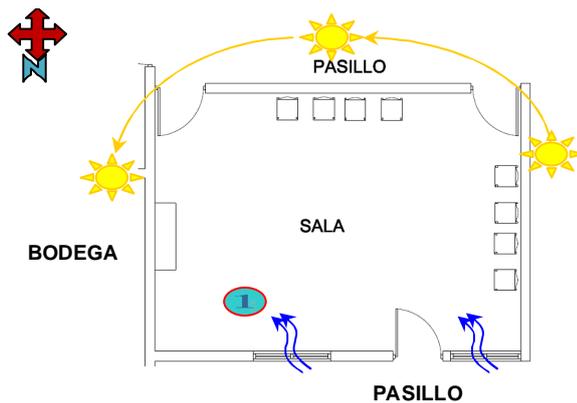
Planta Arquitectónica sala tv. /Fuente: Propia.
